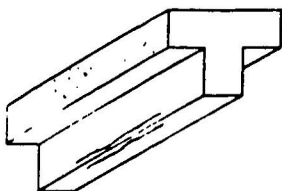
Grietas provocadas por hinchamiento del molde en una vigueta.
